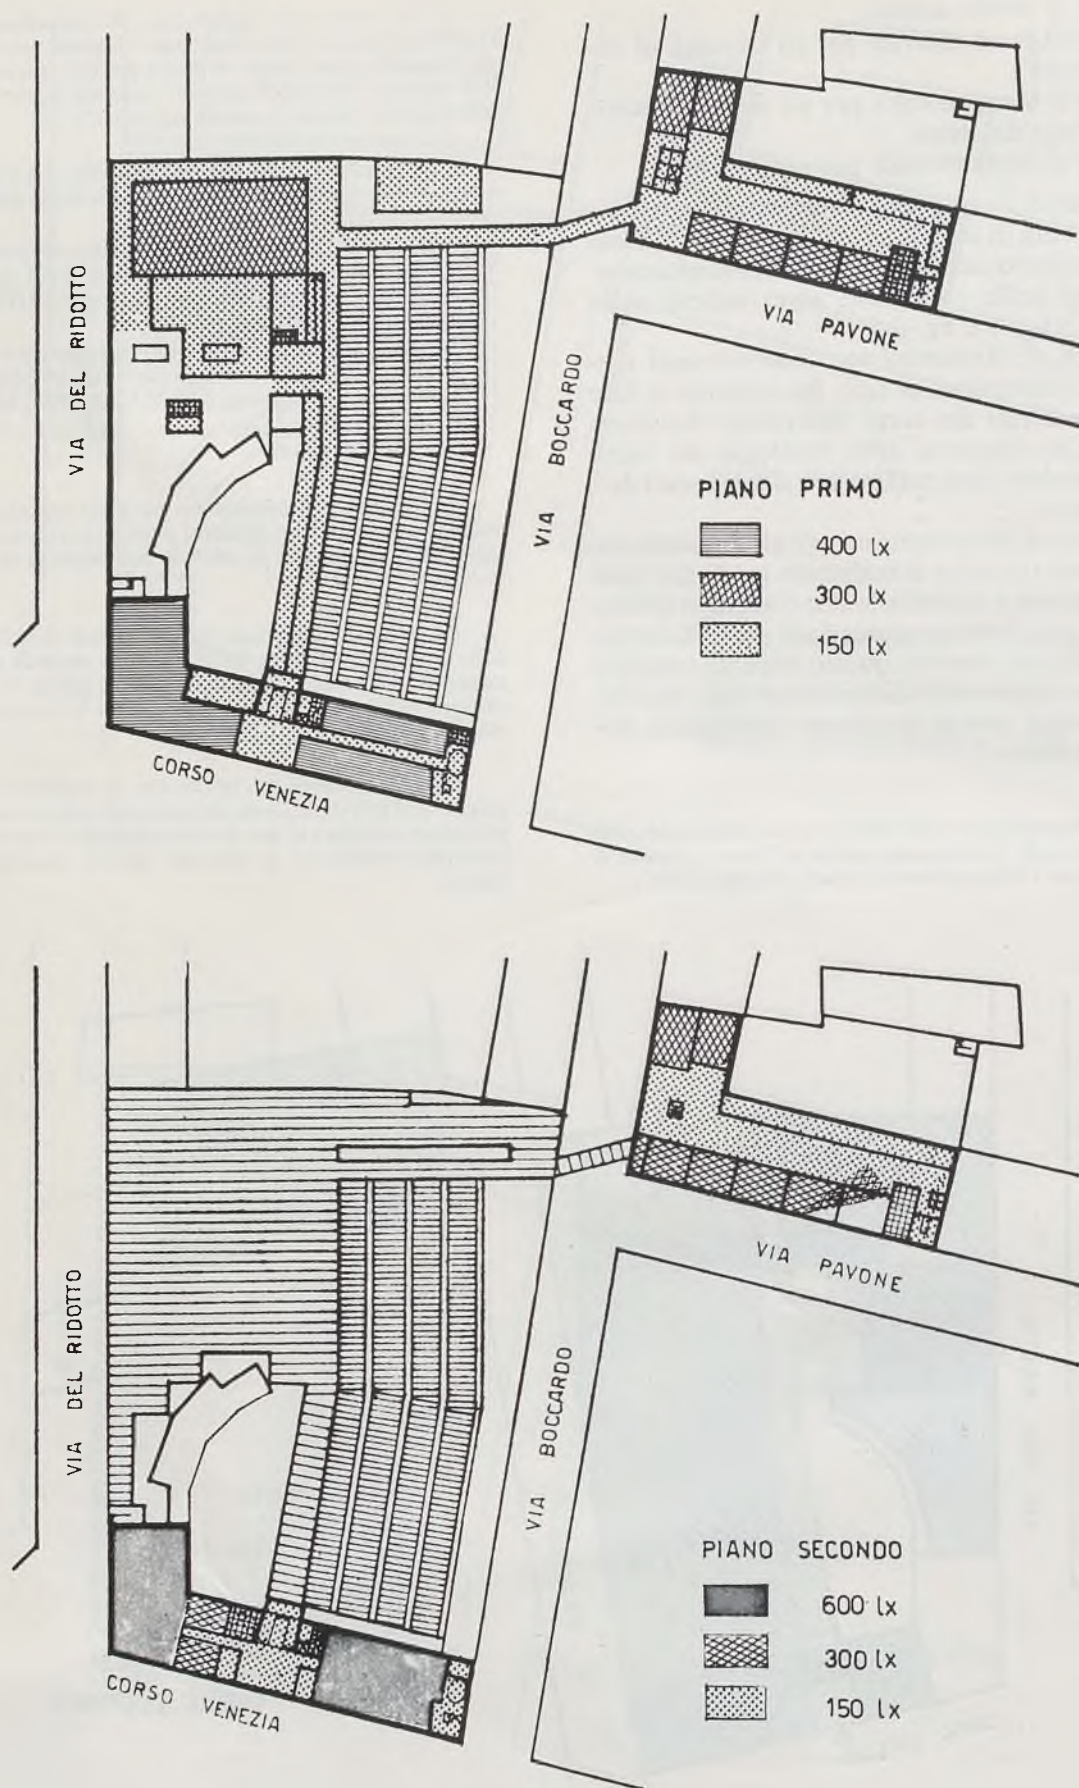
Illuminazione artificiale - Planimetria piani primo e secondo.
